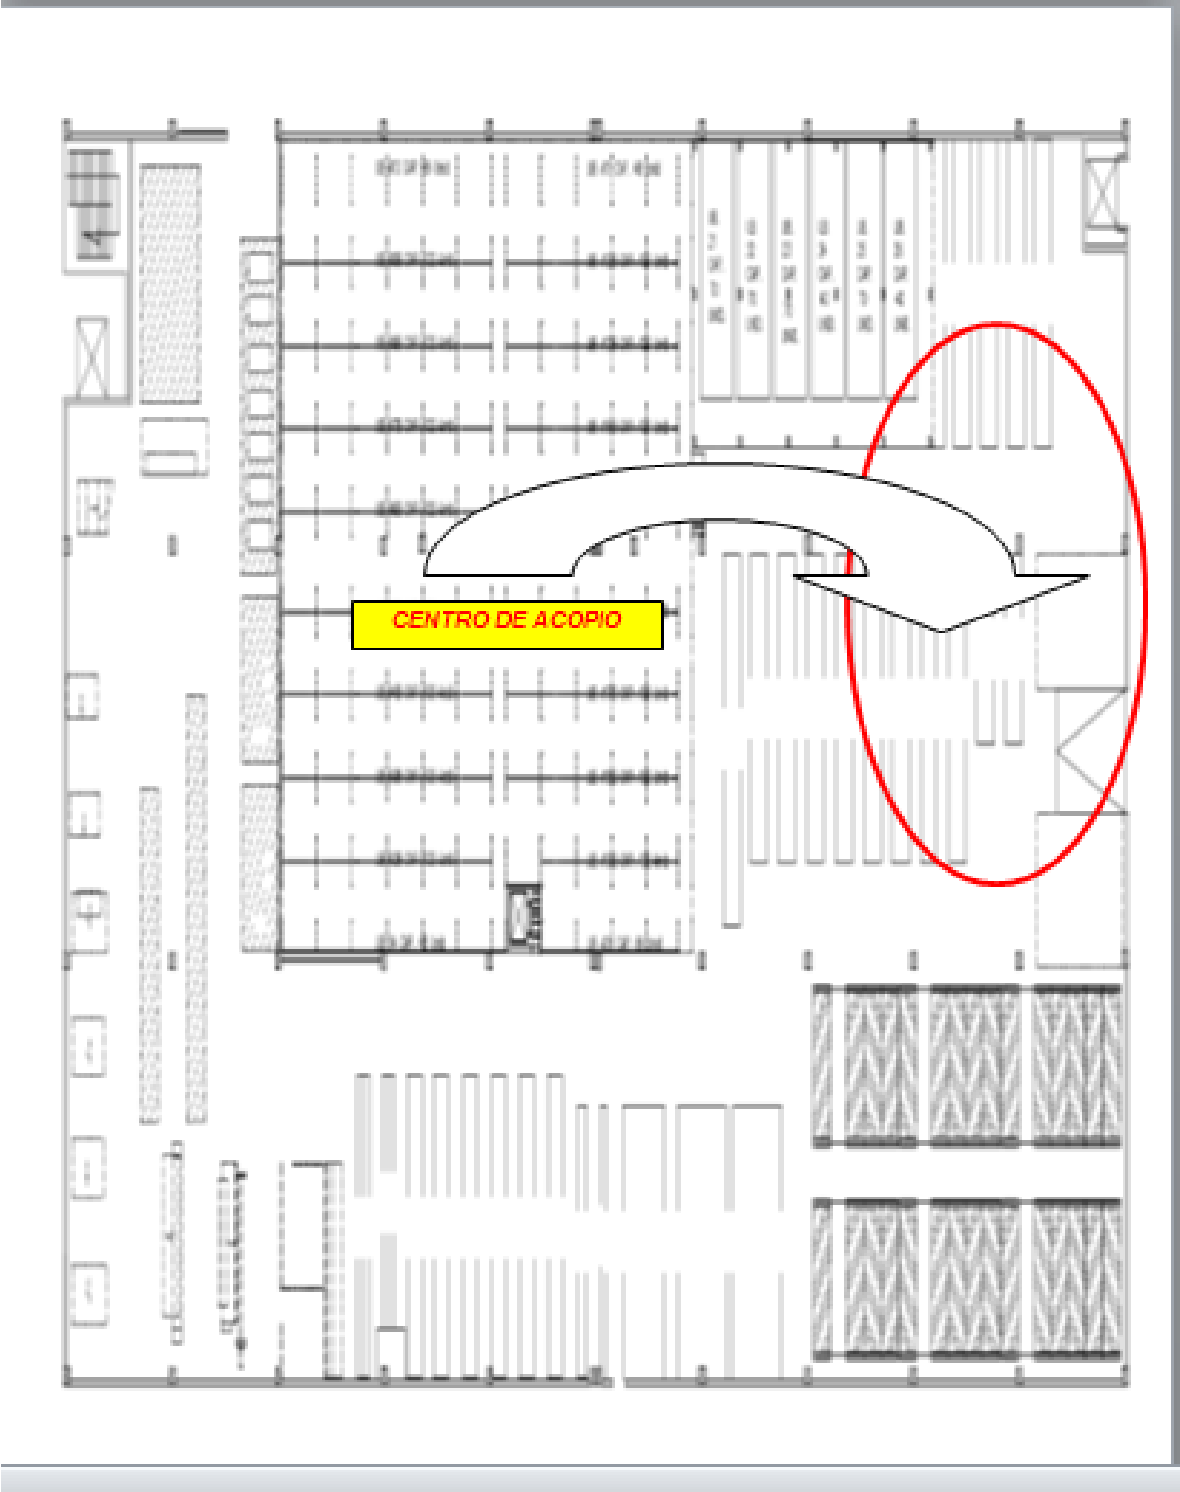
Plano ubicación centro acopio. Fuente Lafayette s.a.s .
